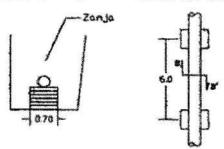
Detalle típico de tubería apoyada en sacos de arena para procedimiento de bajado de sistema GALÁN - AYACUCHO 8" en PK 99+130 a PK 99+370. Fuente: CENIT, 2024.
